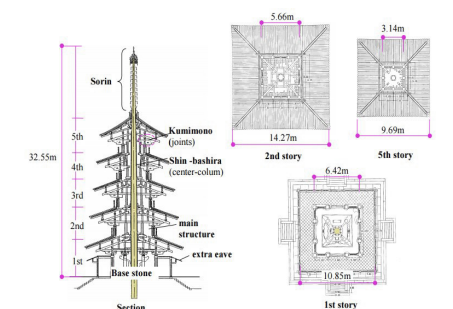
Planos de la pagoda Horyu-Ji en Japón.
